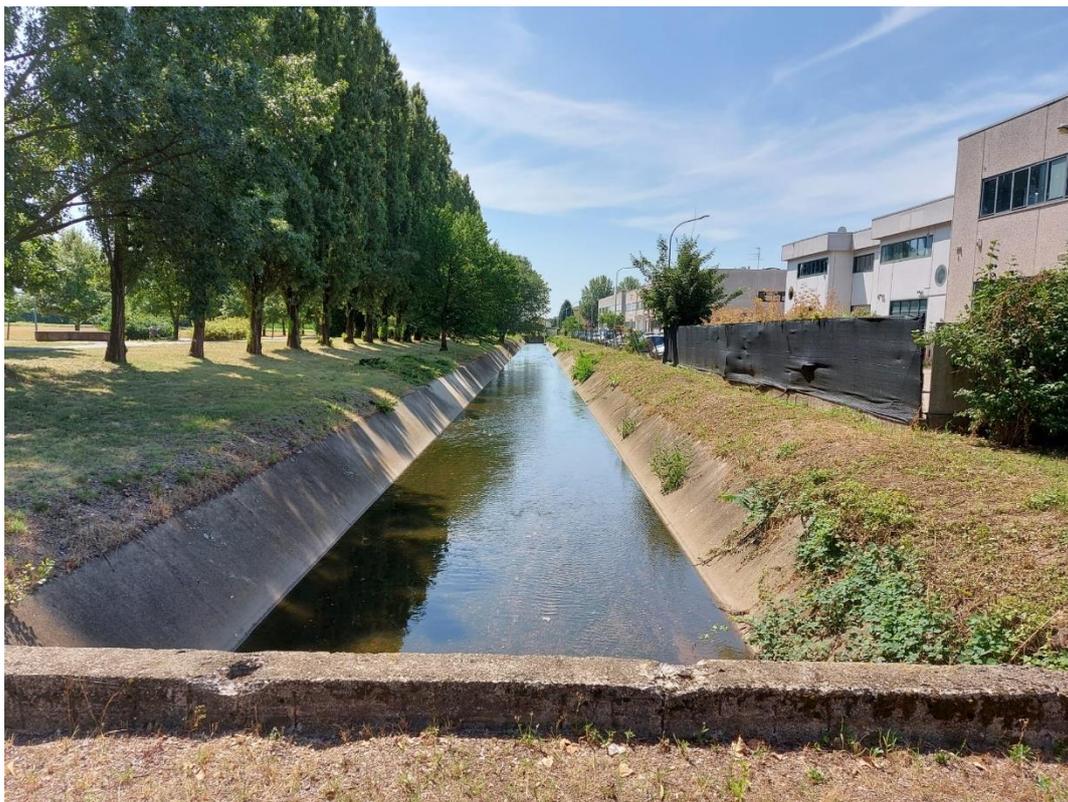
foto del Bozzente nel tratto parallelo a via Prima Strada (vista verso valle)
